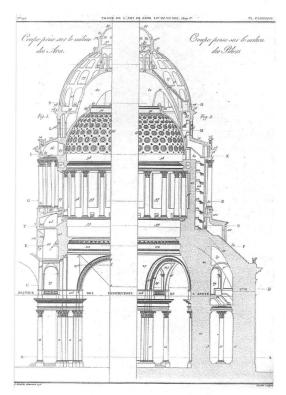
Sección de la cúpula de Santa Genoveva construida por Rondelet (Rondelet [1797], 1834–48)
